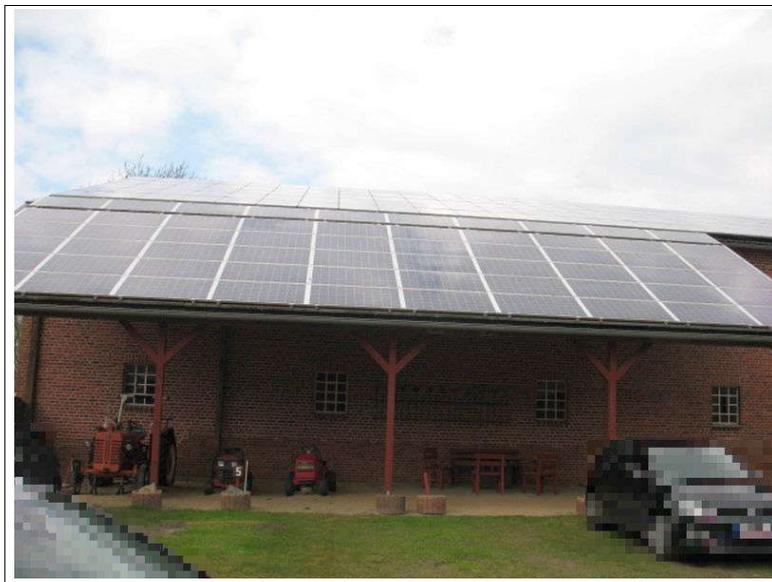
Photovoltaikanlage auf Schleppdachanbau
